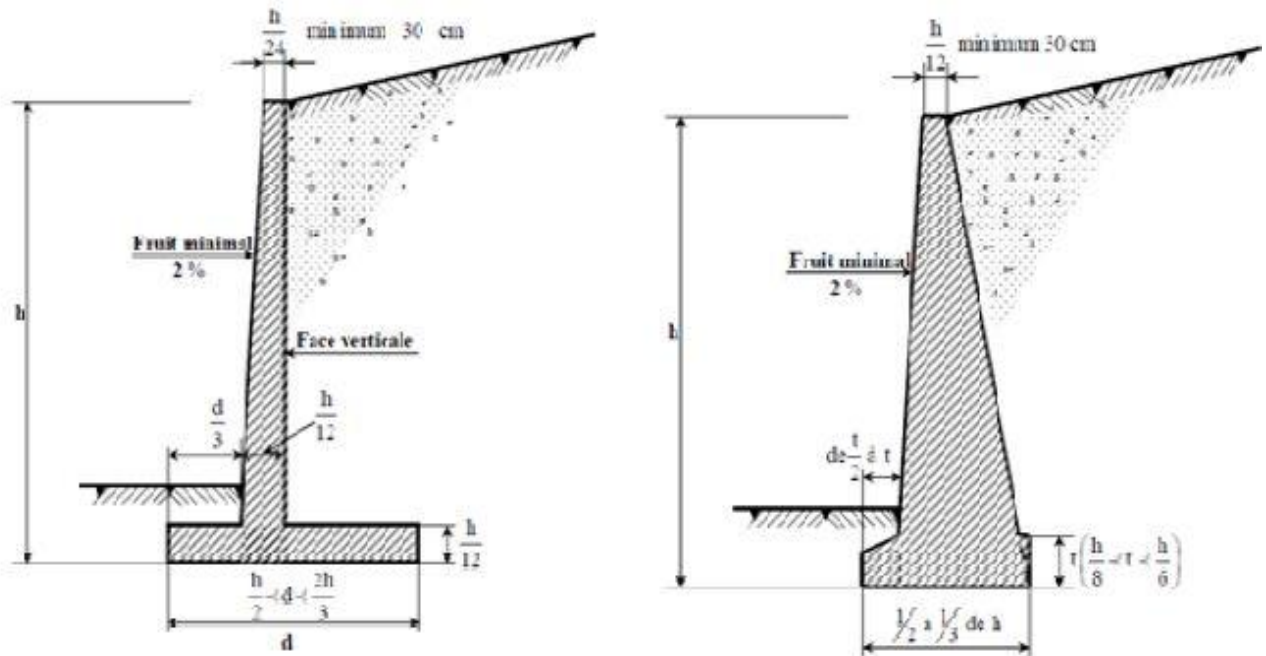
V : Dimensions usuelles d'un mur en béton armé et un mur poids.
